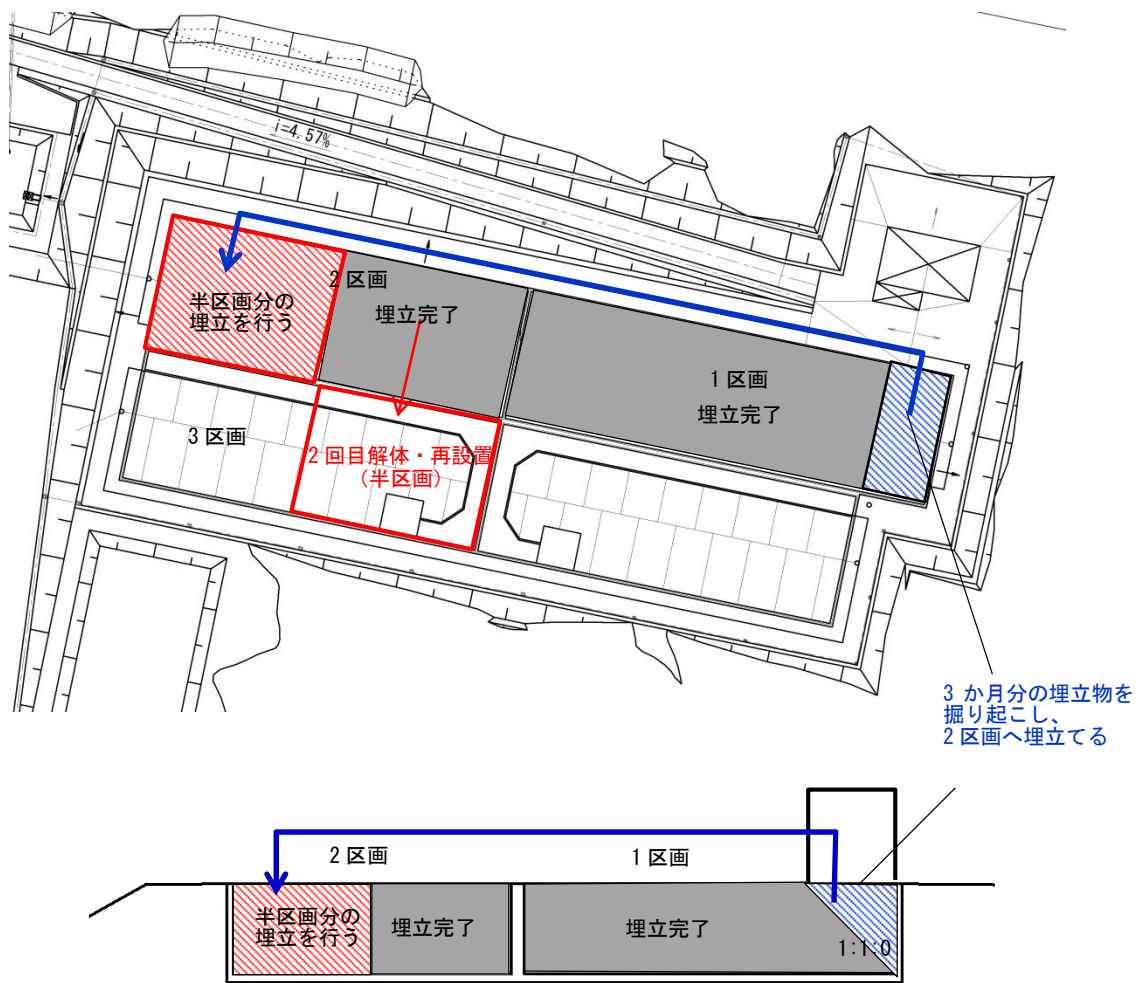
埋立地平面図・標準断面図 (2 回目・上屋解体・再設置時②)
